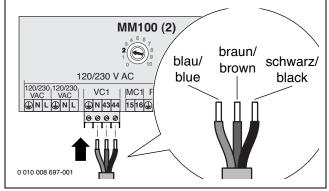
Raccordement du câble du moteur du mélangeur sur le module MM100 [2]
